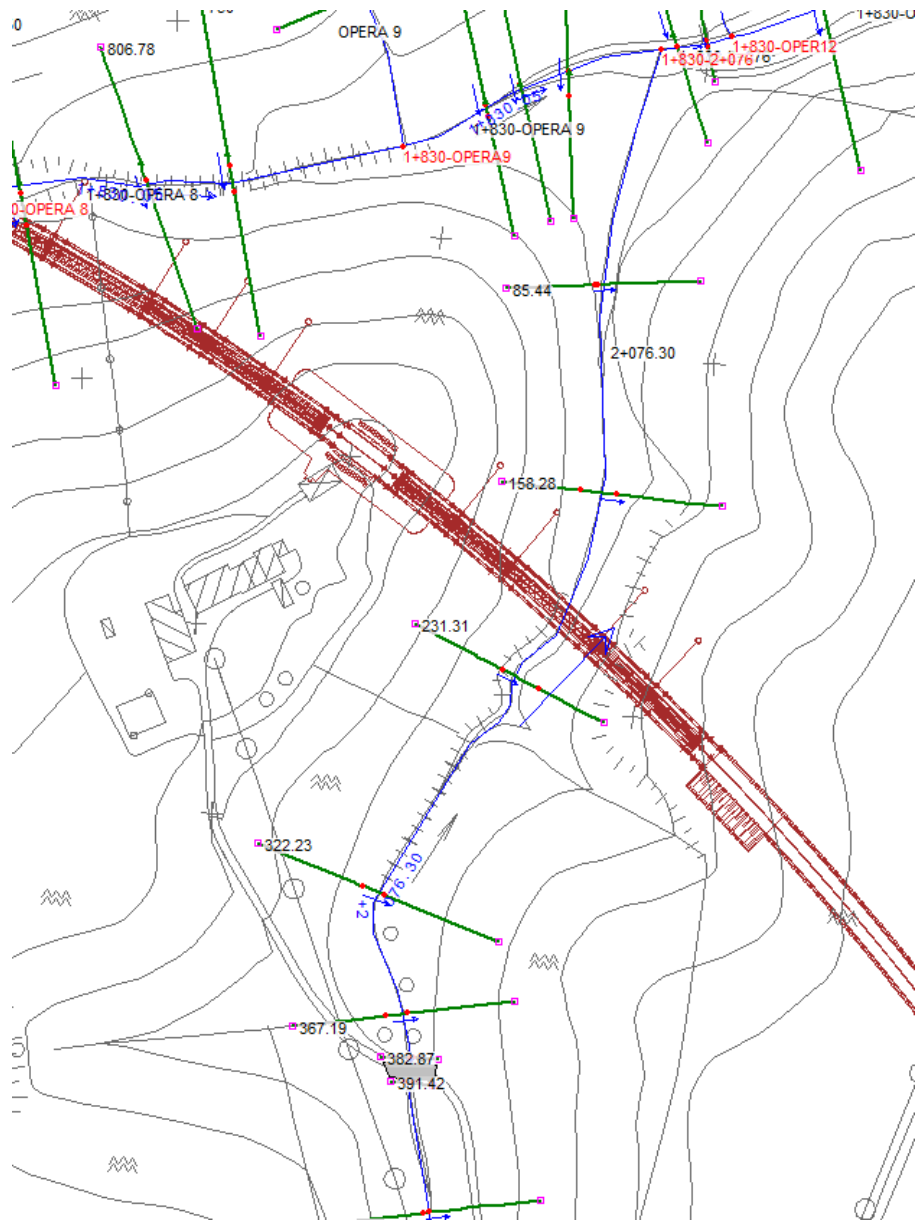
Planimetria Hec ras – sovrapposizione SDF – linea di progetto
